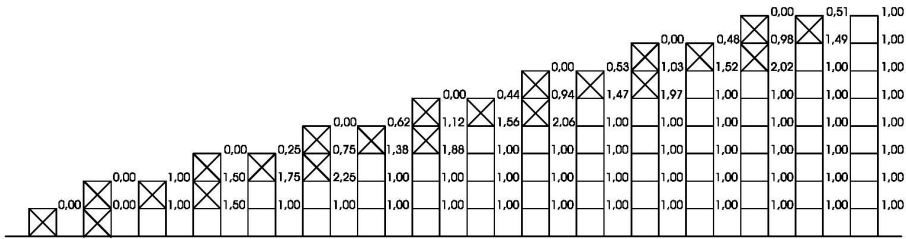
Factor de carga, en los forjados, con dos juegos de cimbras en un edificio de ocho plantas, sobre solera infinitamente rígida.
